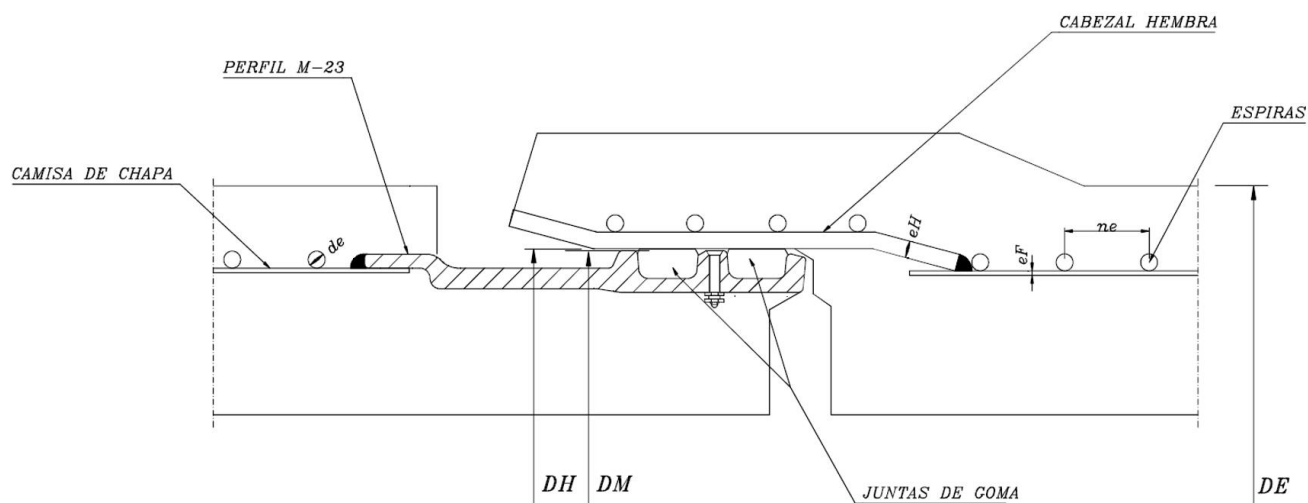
Junta elástica doble en tubería de hormigón postesado con camisa de chapa.
